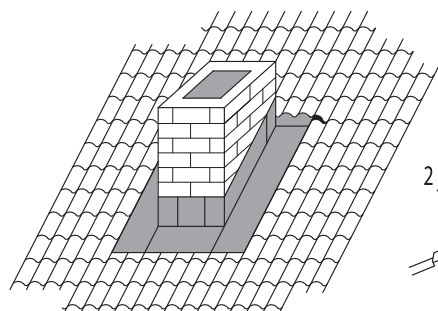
Гидроизоляция трубы с разъемом в кровле
